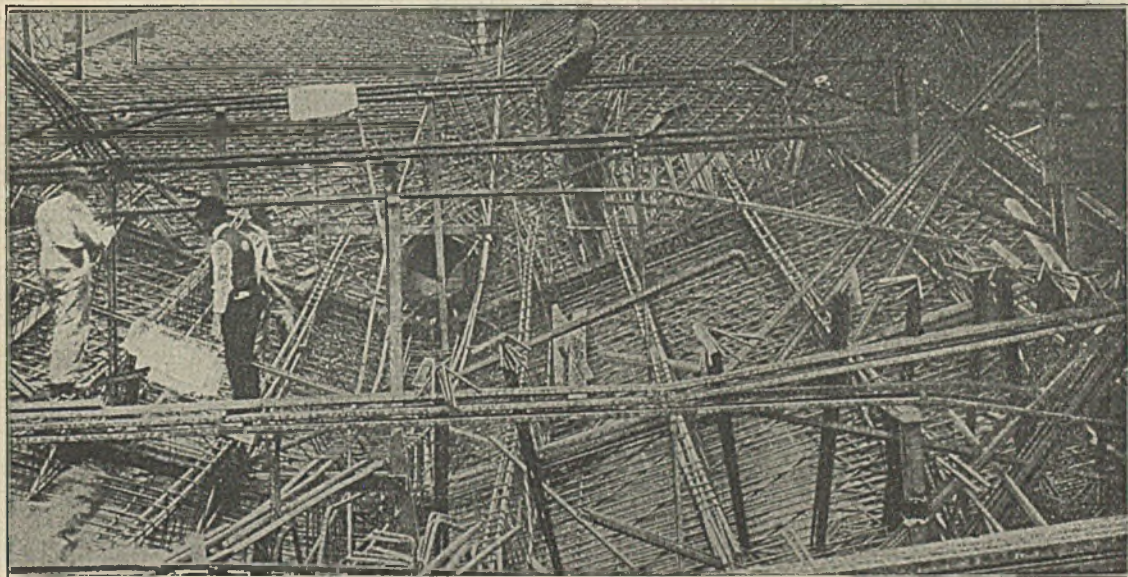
Bewehrung am Stoverrohr für die Schraubenwelle des 5000 t-Schiffes.
